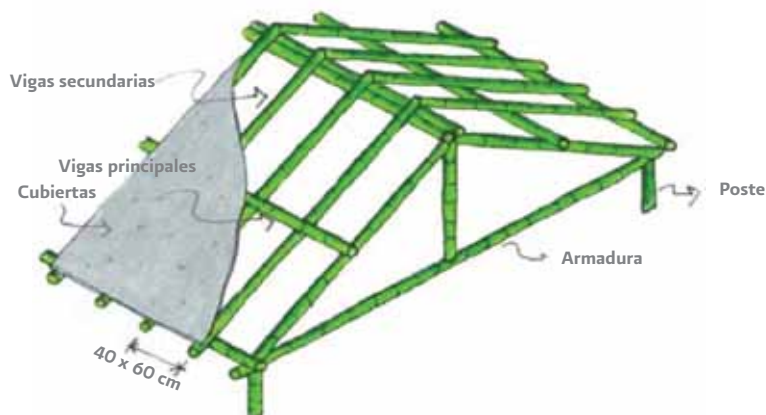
Techo o cubierta de la forma más sencilla construida con bambú.
